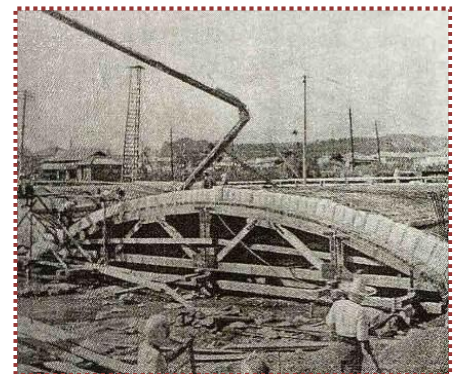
アーチ部の施工状況（『兵庫を築く』から引用）
